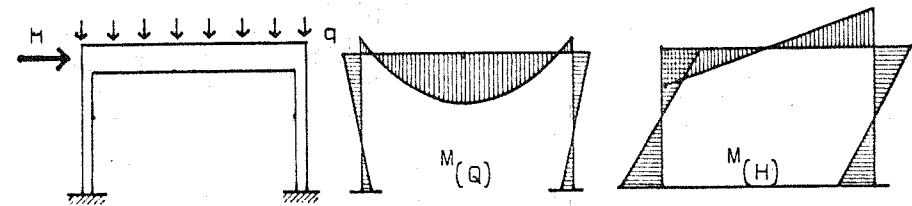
Si la viga es muy rígida la acción de pórtico sólo es notable para las cargas horizontales
